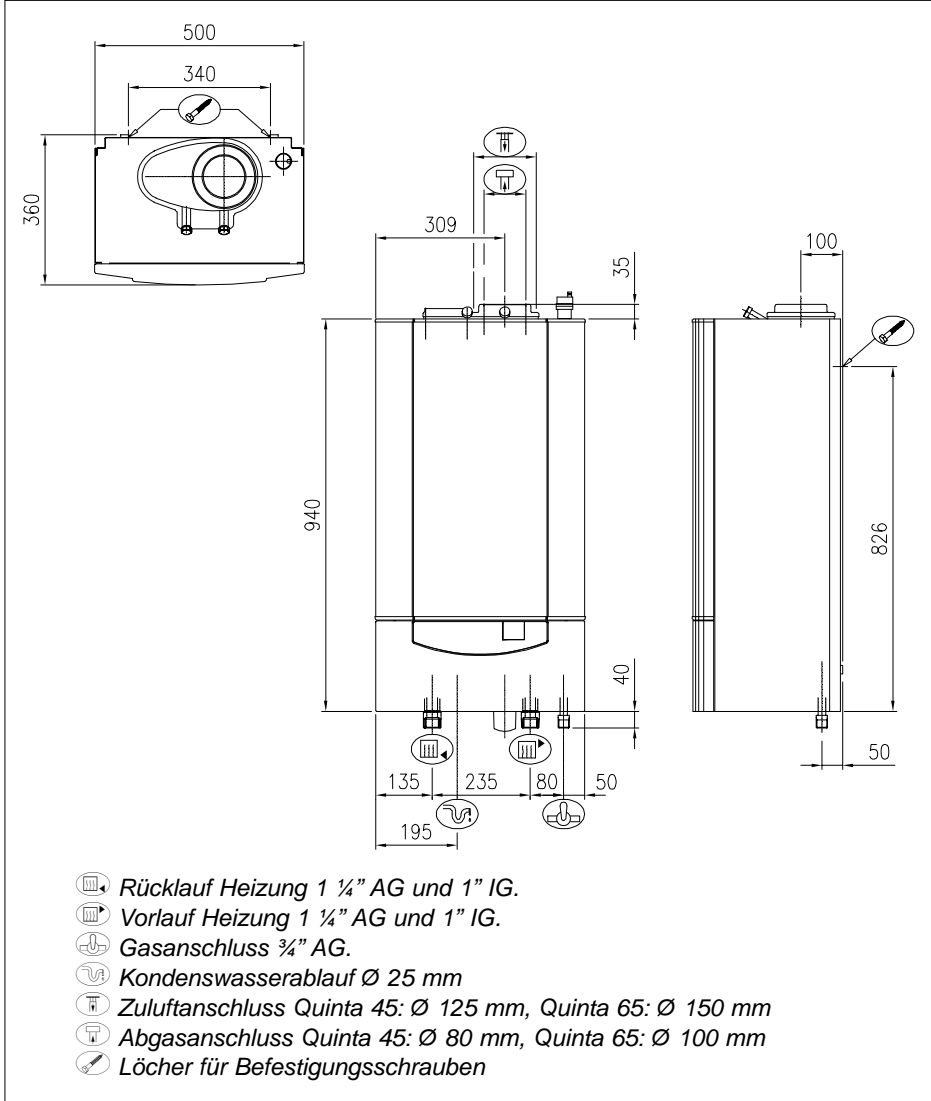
Abmessungen Remeha Quinta 45 und Remeha Quinta 65
